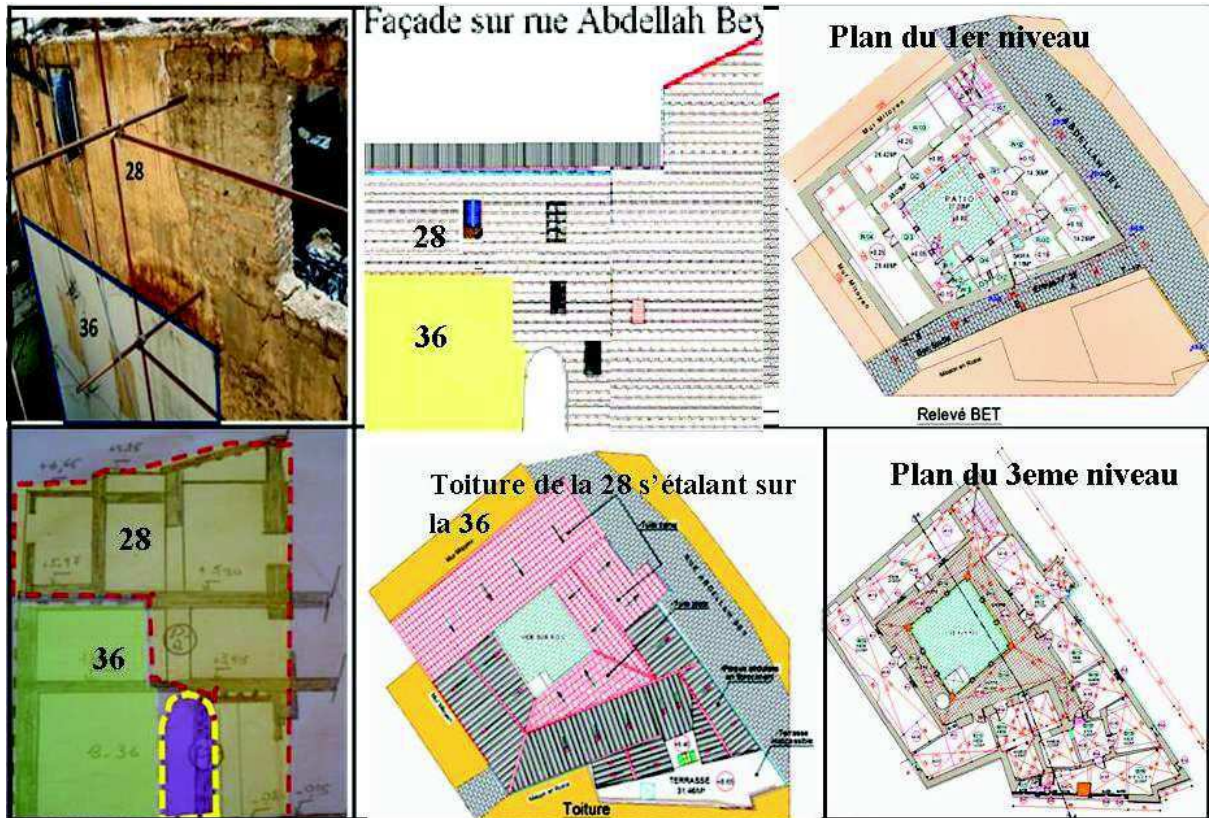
FIG : En haut une photo en bas une coupe montrant l'Emboitement de la maison 28 sur la maison 36.
